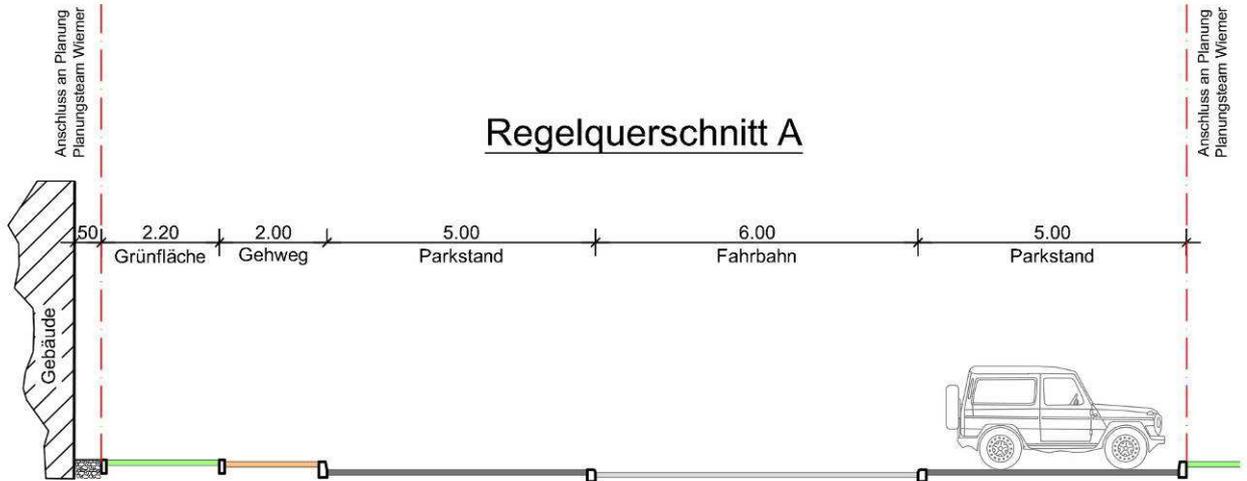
Querschnitt A - A in Planstraße A (Brilon Bondzio Weiser, Juli 2021)
